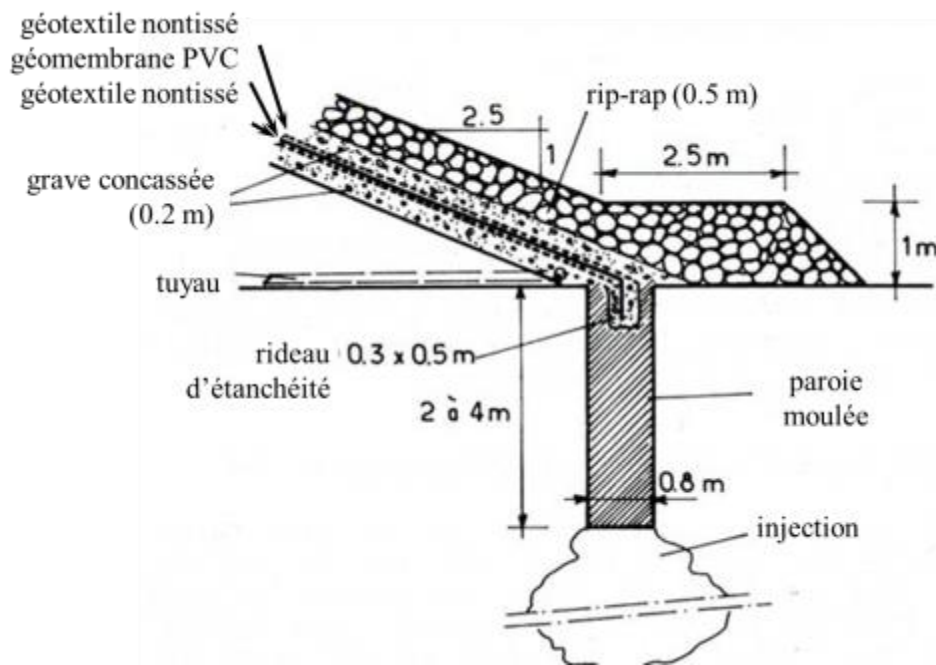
Barrage de l'Aubrac : Coupe de l'étanchéité amont en pied de barrage
